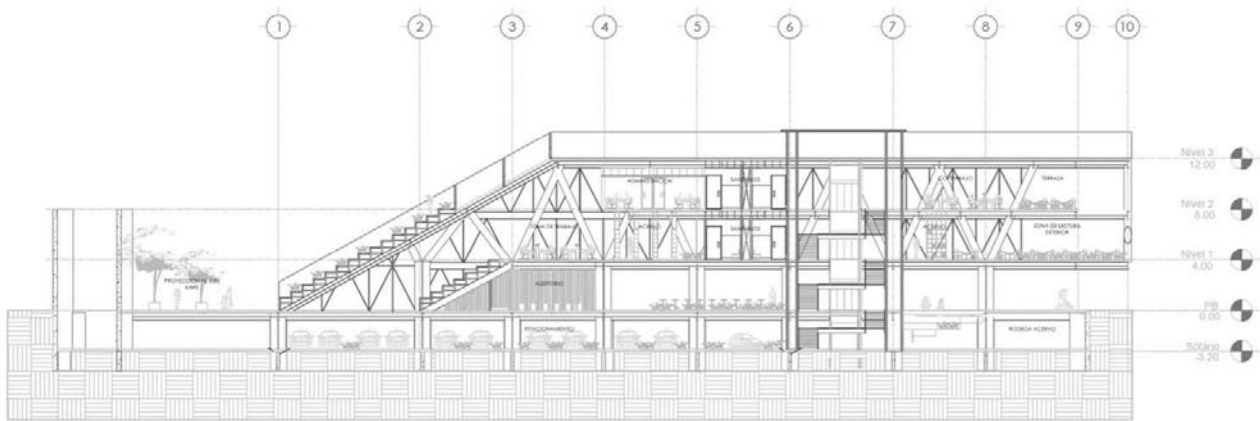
Plano de corte longitudinal, [elaboración propia].
